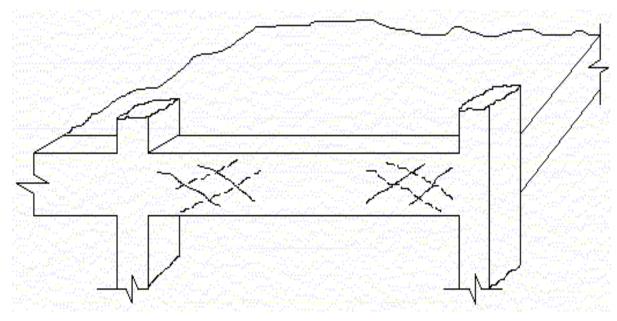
Fissuras devidas a torção de viga.
